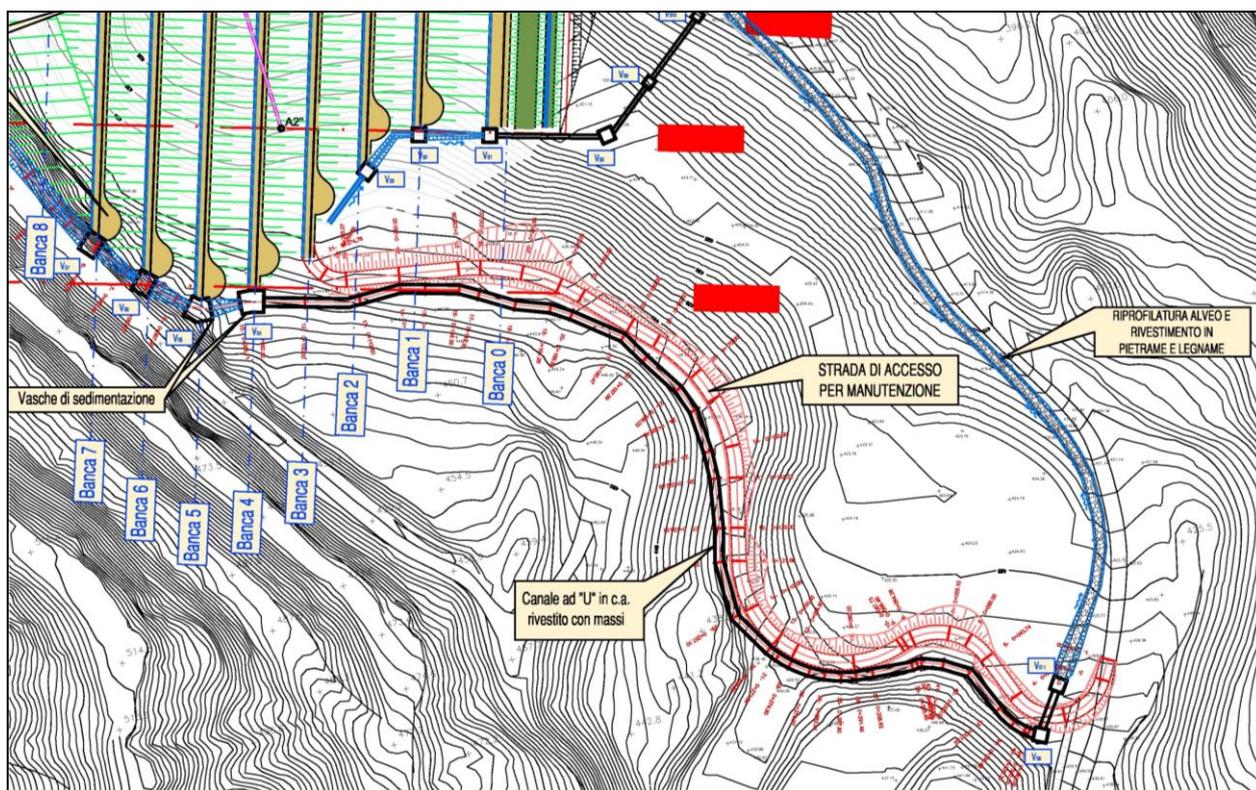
Viabilità di accesso abbancamento – Planimetria
